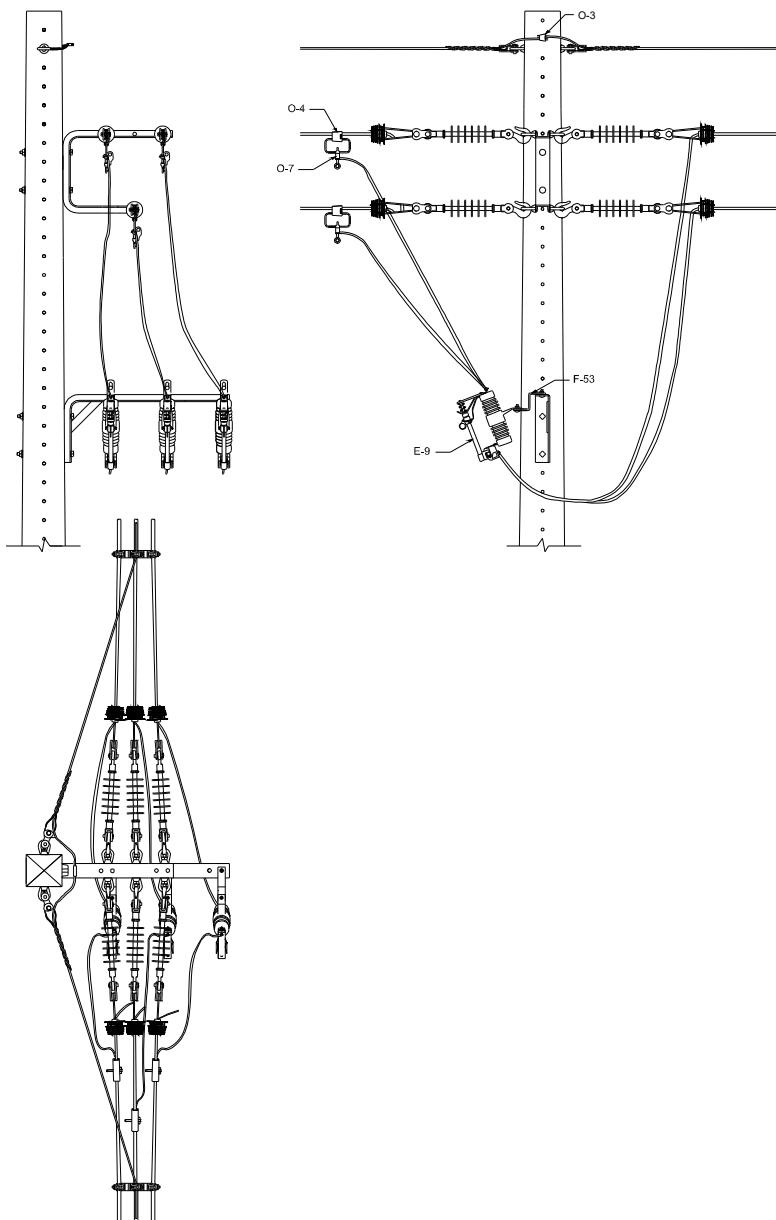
Instalação de equipamento – Chave fusível – Seccionamento – Estrutura trifásica – Suporte horizontal
